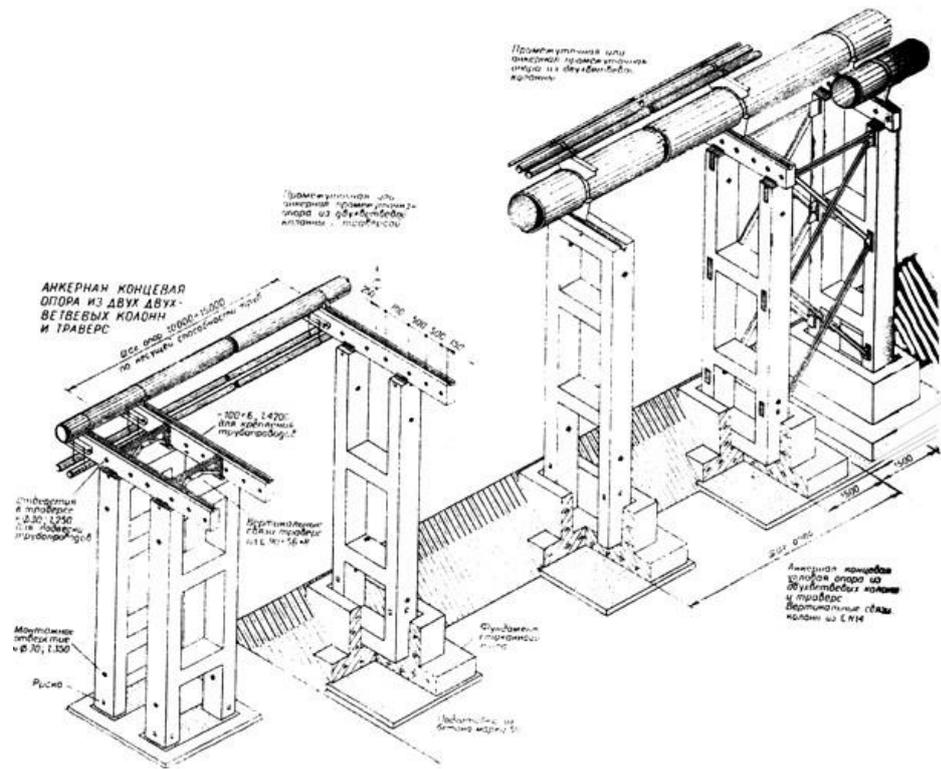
Общий вид несущих опорных конструкций надземного трубопровода
